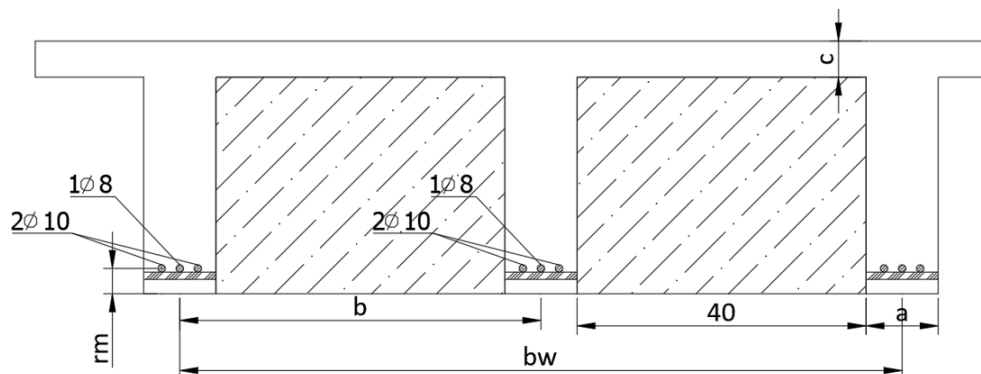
Disposición de armadura para M_x máximo positivo.
